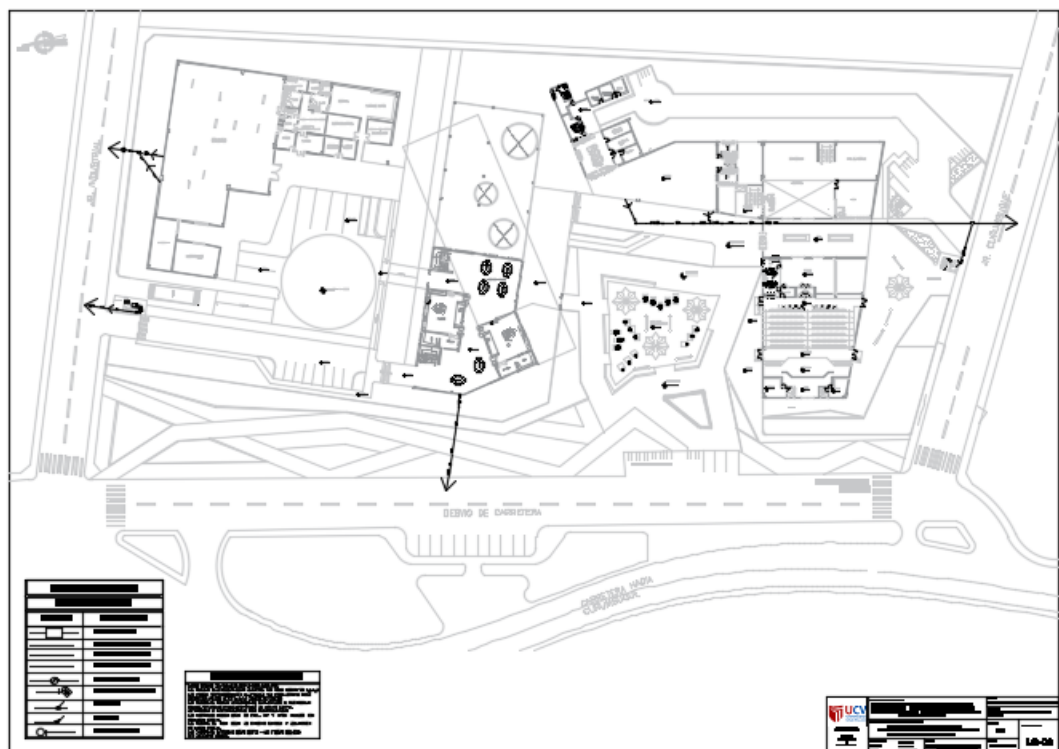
Instalaciones Sanitarias : Desagüe - Planta general
